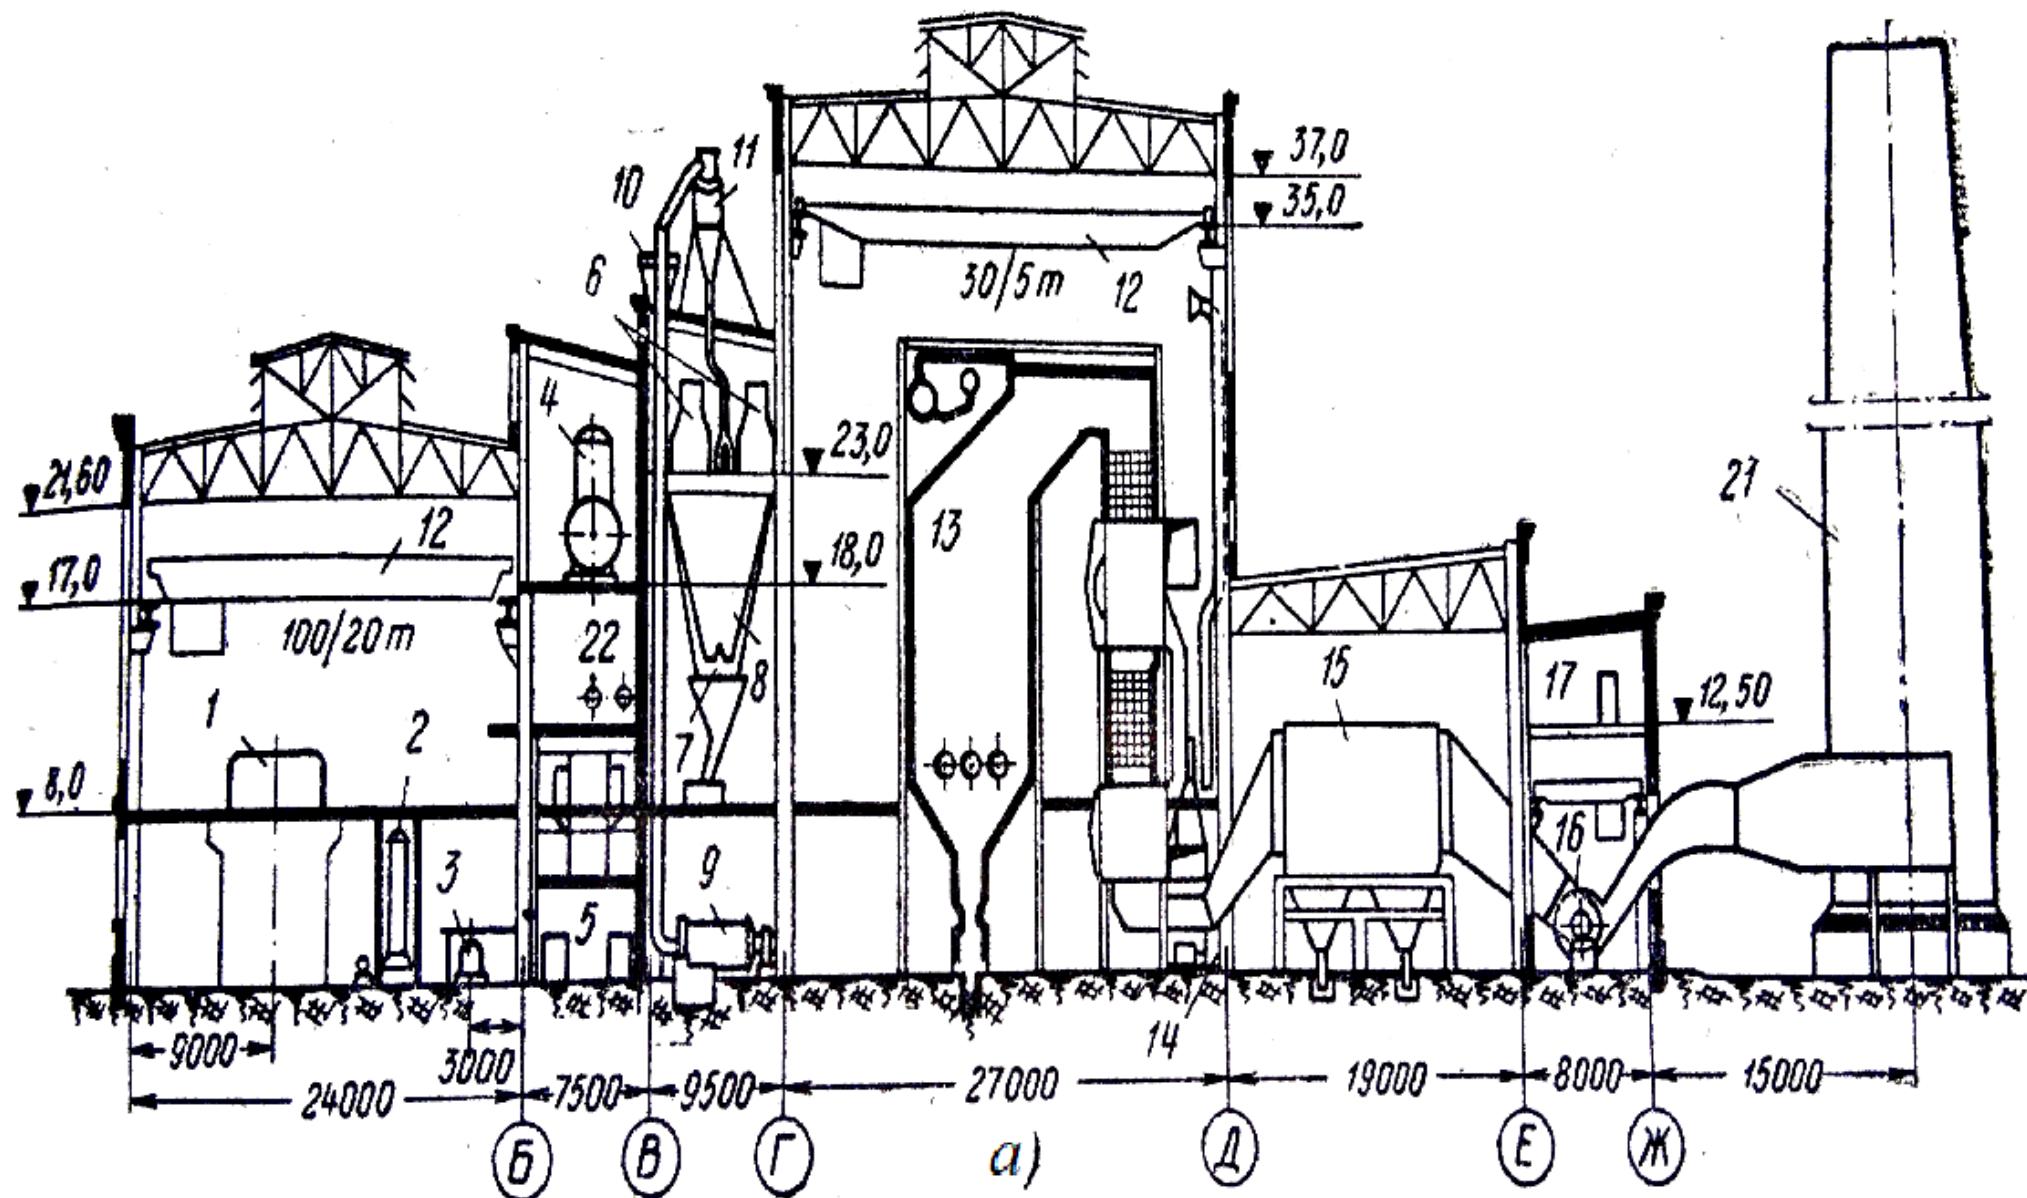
(а) Компоновка главного корпуса пылеугольной ТЭС с поперечными связями. (План)
